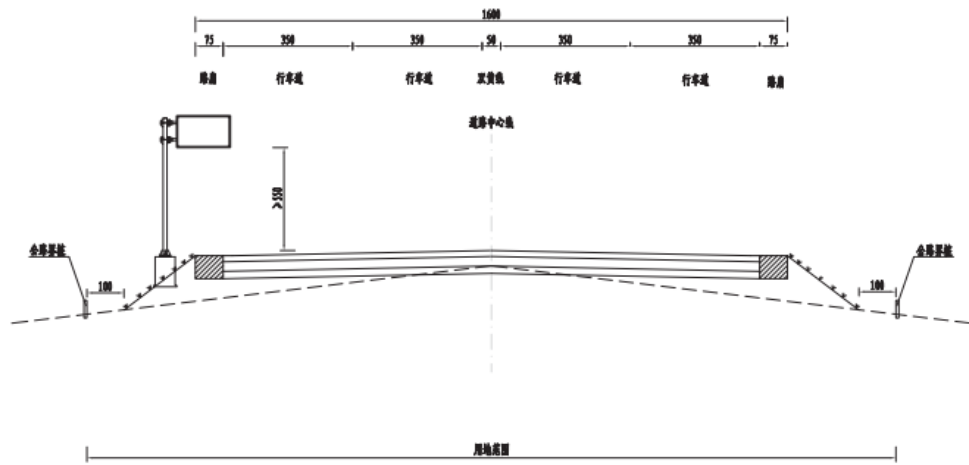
16m 路基横断面图 (K0+320—K0+650)
